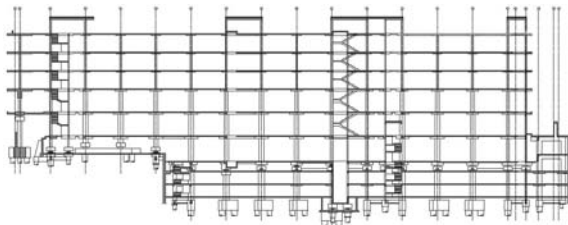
Sezione longitudinale dell'edificio ospedaliero.
